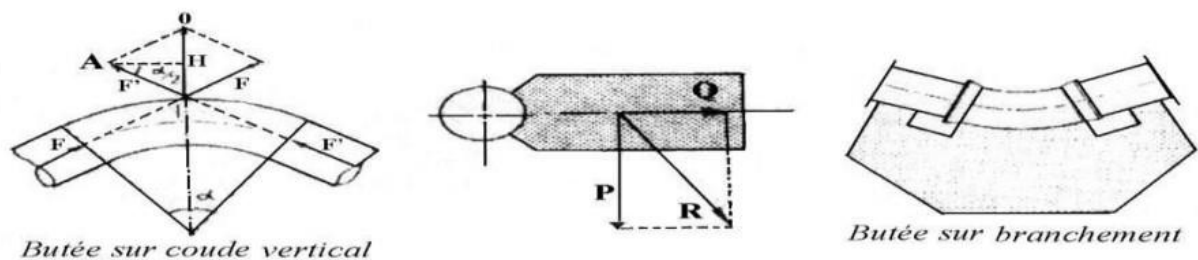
Butée sur coude vertical et Butée sur branchement.
